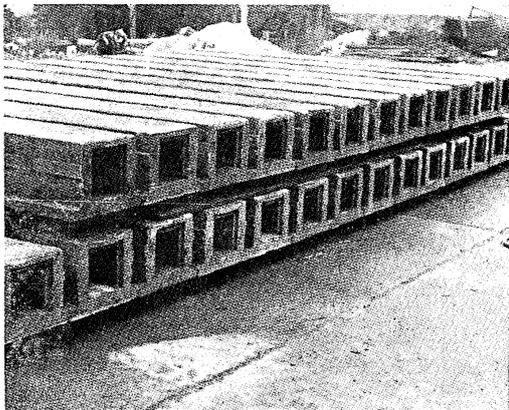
Elementos de aislamiento acústico de techo en hormigón ligero de Styropor (densidad aparente, 0,6 kg/m³).
